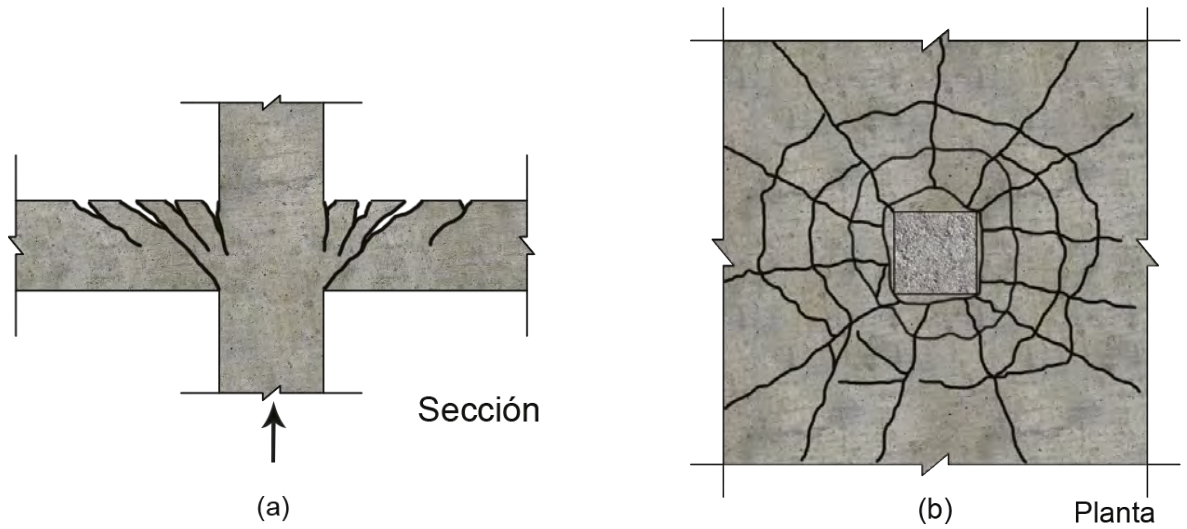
Agrietamiento por punzonamiento alrededor de una columna.
